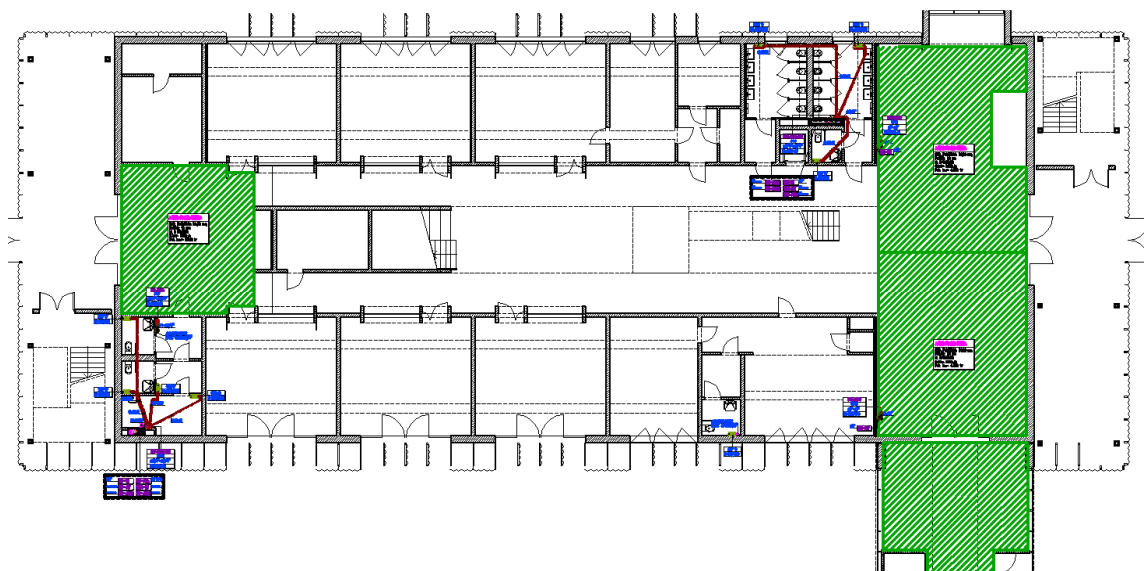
Pianta piano terra palestra: impianto termico in progetto
